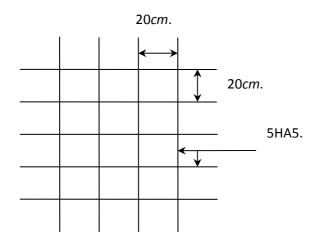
Fig III-A- Ferraillage de dalle de compression Avec un treille soudée.
